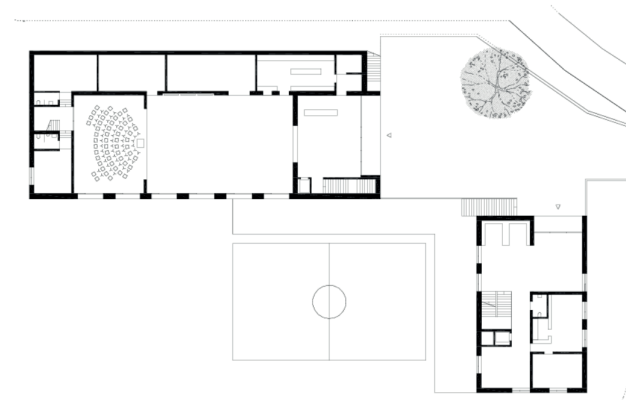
Schule und Saal Laterns Grundriss EG
